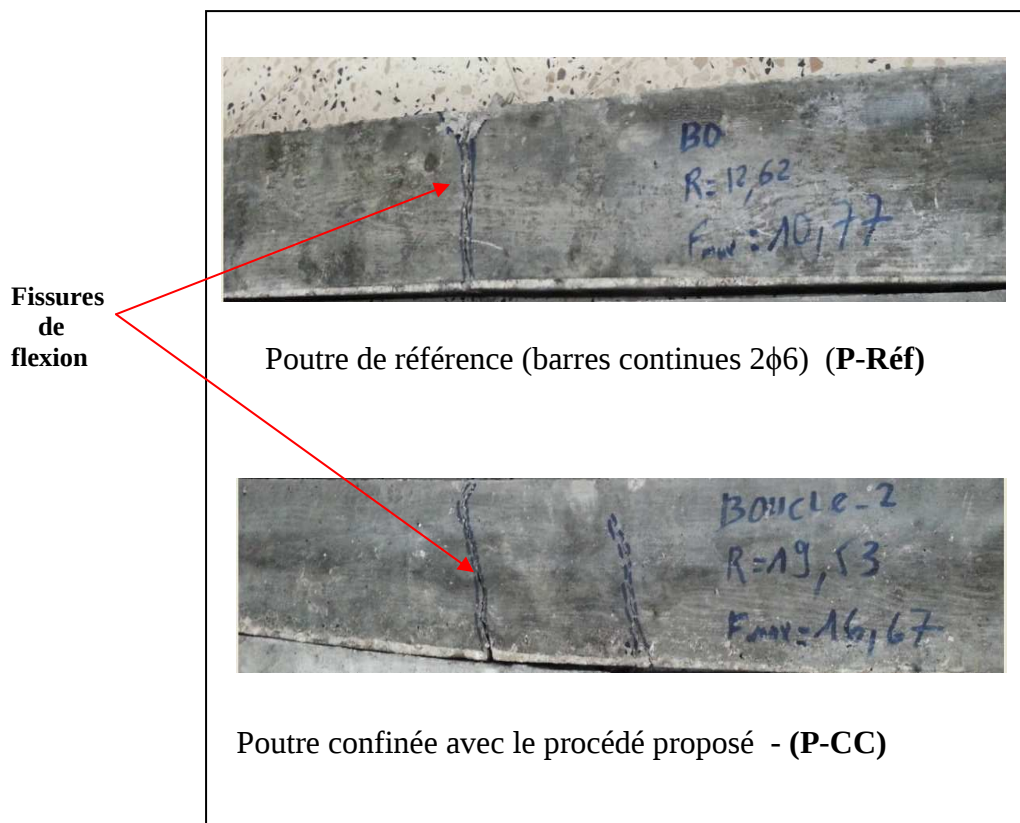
Modes de rupture par flexion des différentes poutres selon le ferrailage adopté
